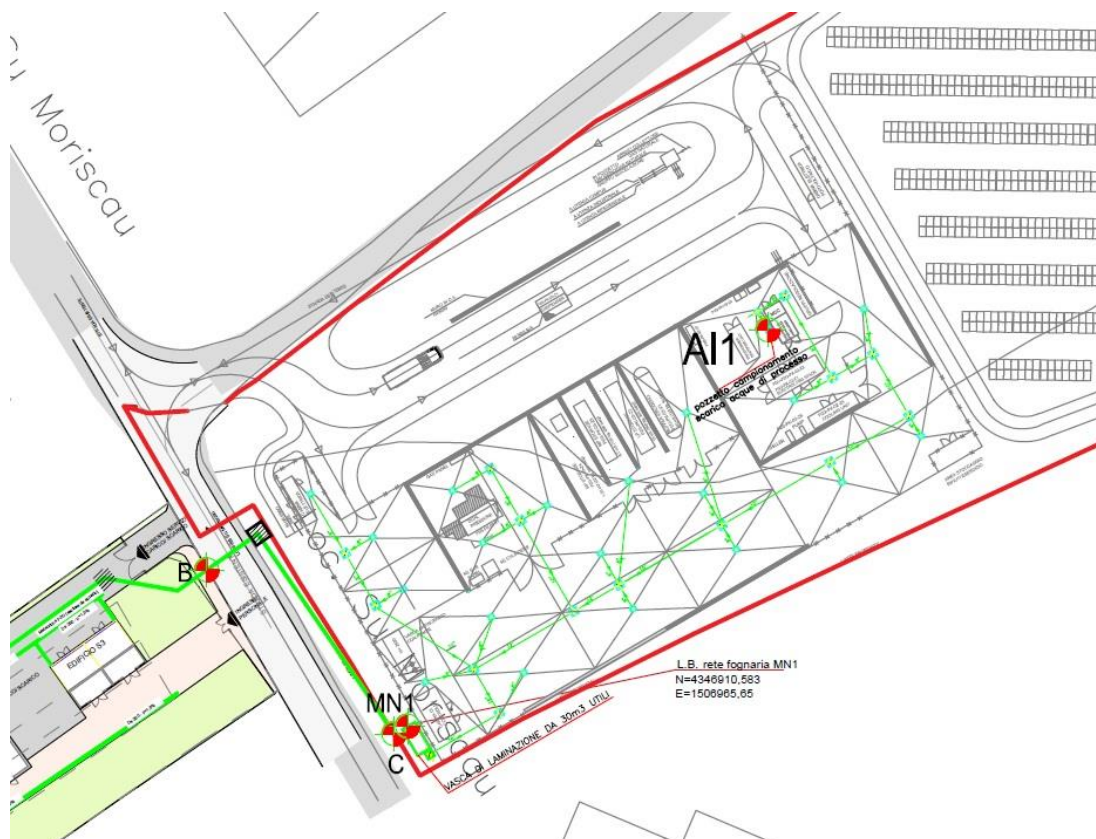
Planimetria reti fognarie – dettaglio area impianto P2G
